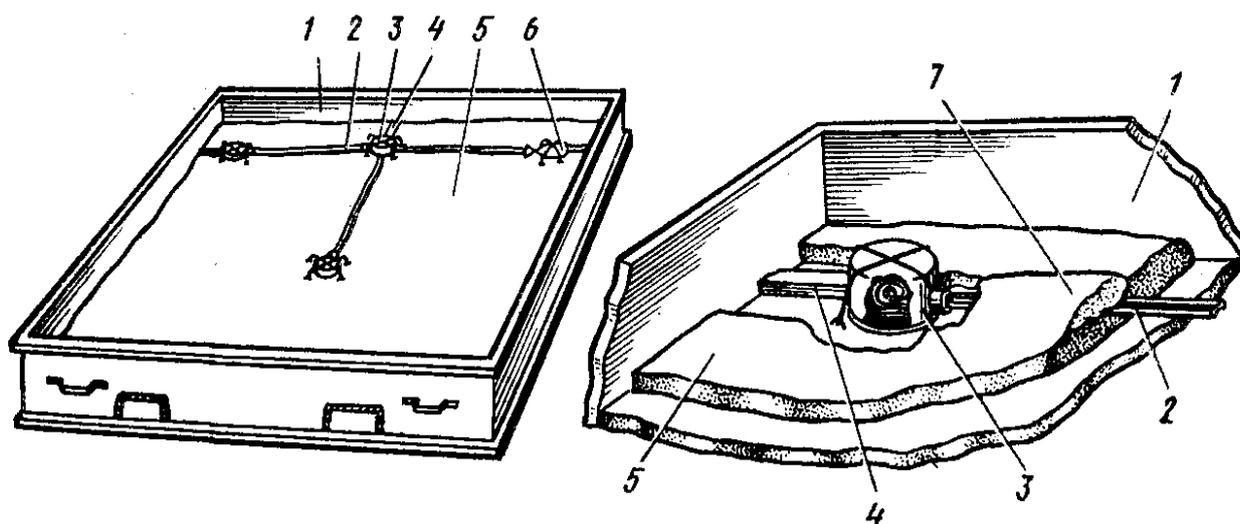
Замоноличивание заготовки электропроводки в стеновую шлакобетонную панель: 1 - форма (опалубка) для изготовления стеновой панели; 2 - провод; 3 - соединительная коробка; 4 - стальной прилив; 5 - слой раствора; 6 - «запас провода»; 7 - защитный слой раствора
